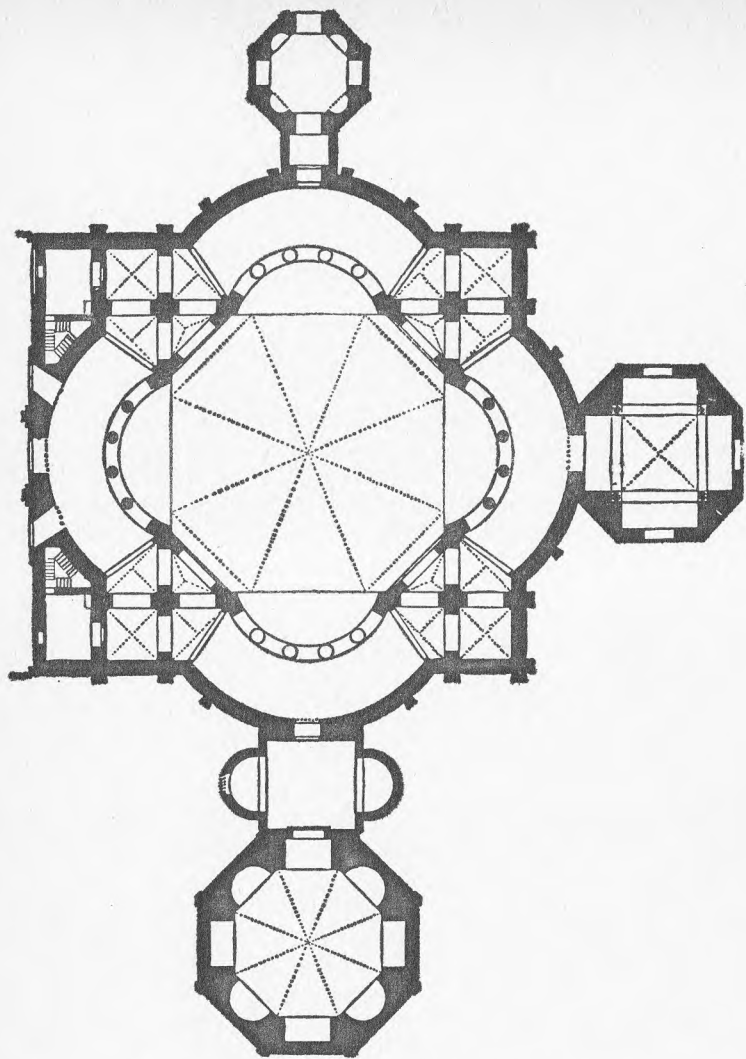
Mailand. San Lorenzo. 5. Jb. Grundriß des bestehenden Baus
